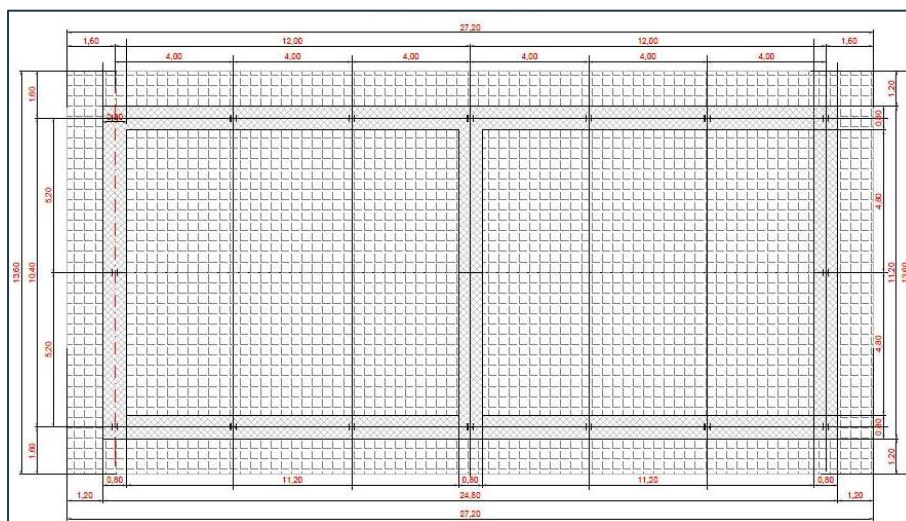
pianta fondazioni edificio ricovero mezzi agricoli
